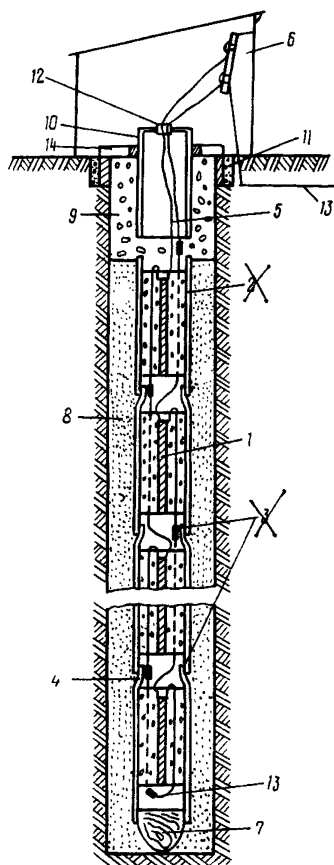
Общий вид глубинного заземления из заземлителей типа АК-2Г:
